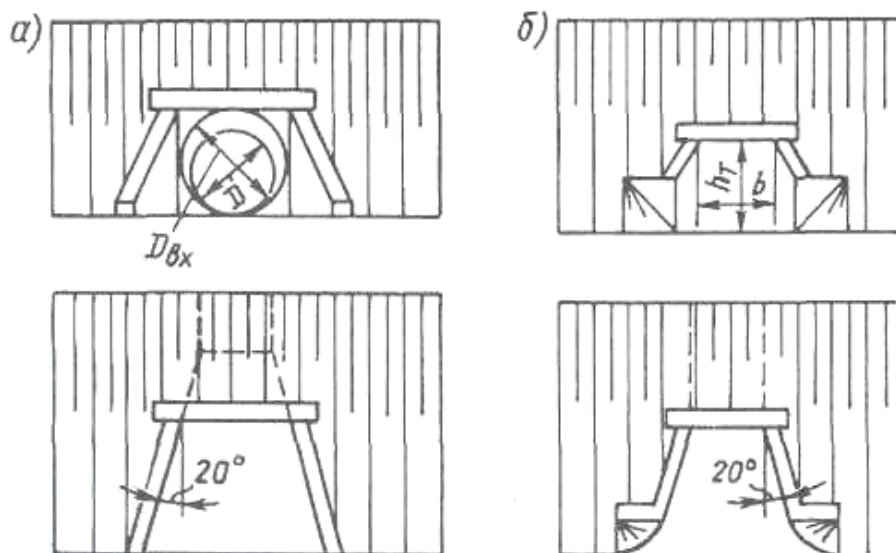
Типи залізобетонних і бетонних труб (фасад і план): а – кругла з конічним і розтрубним оголовком; б – прямокутна з розтрубним оголовком зі зворотними стінками
